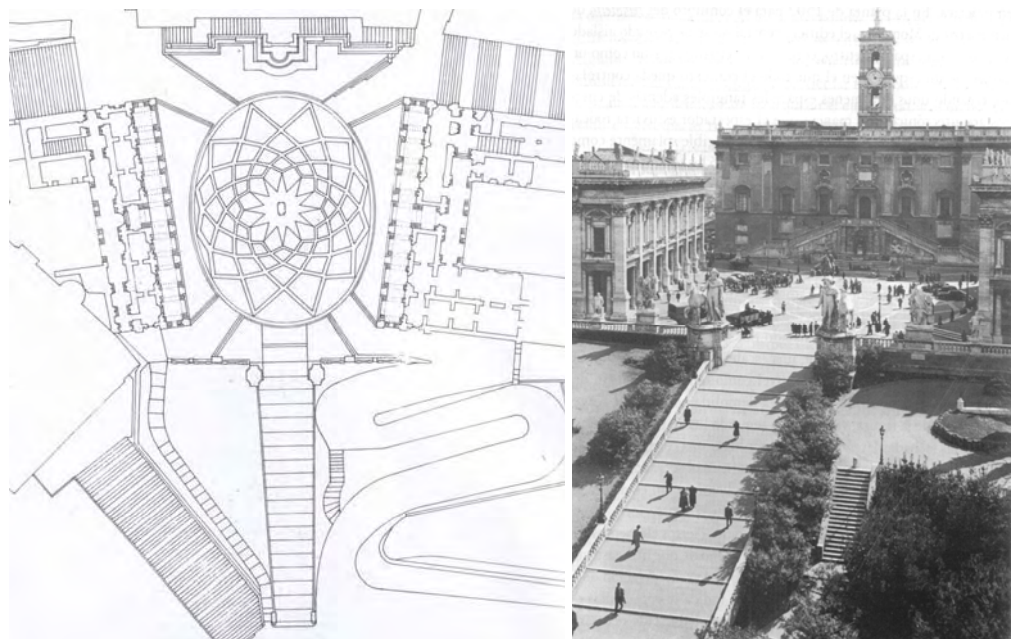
Planta baixa do nível térreo do Capitólio (FURNARI, 1995, p. 146) e vista geral (ACKERMAN, 1997, p. 135).
